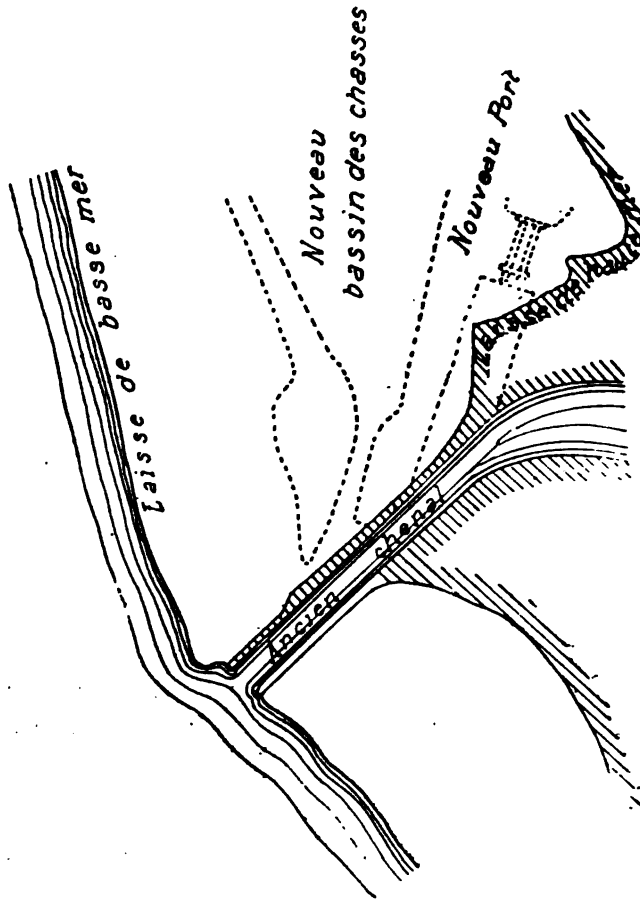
Plan des anciens et nouveaux ouvrages de Calais.
